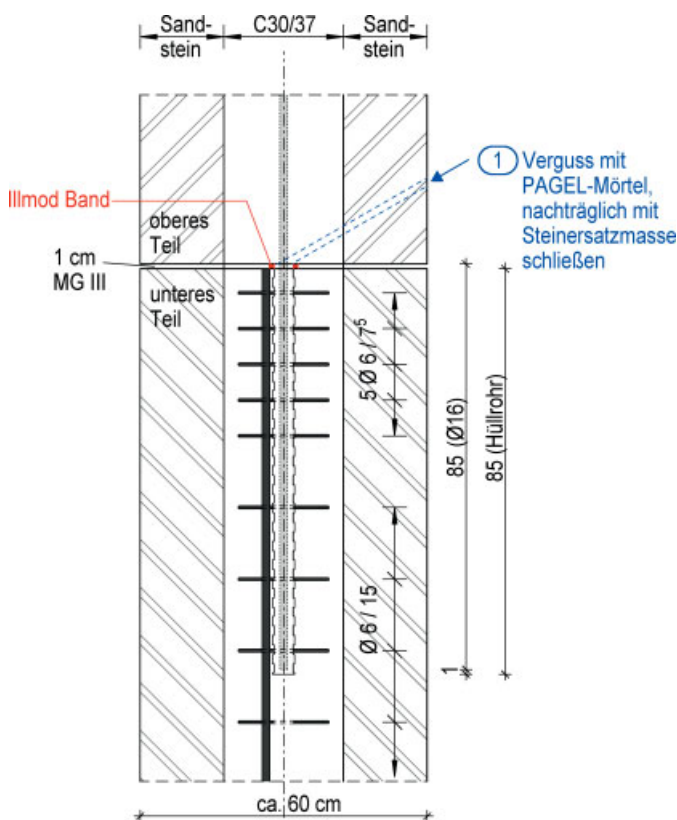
Stützenstoß einer mit Betonkern ertüchtigten Stütze, Vertikalschnitt
